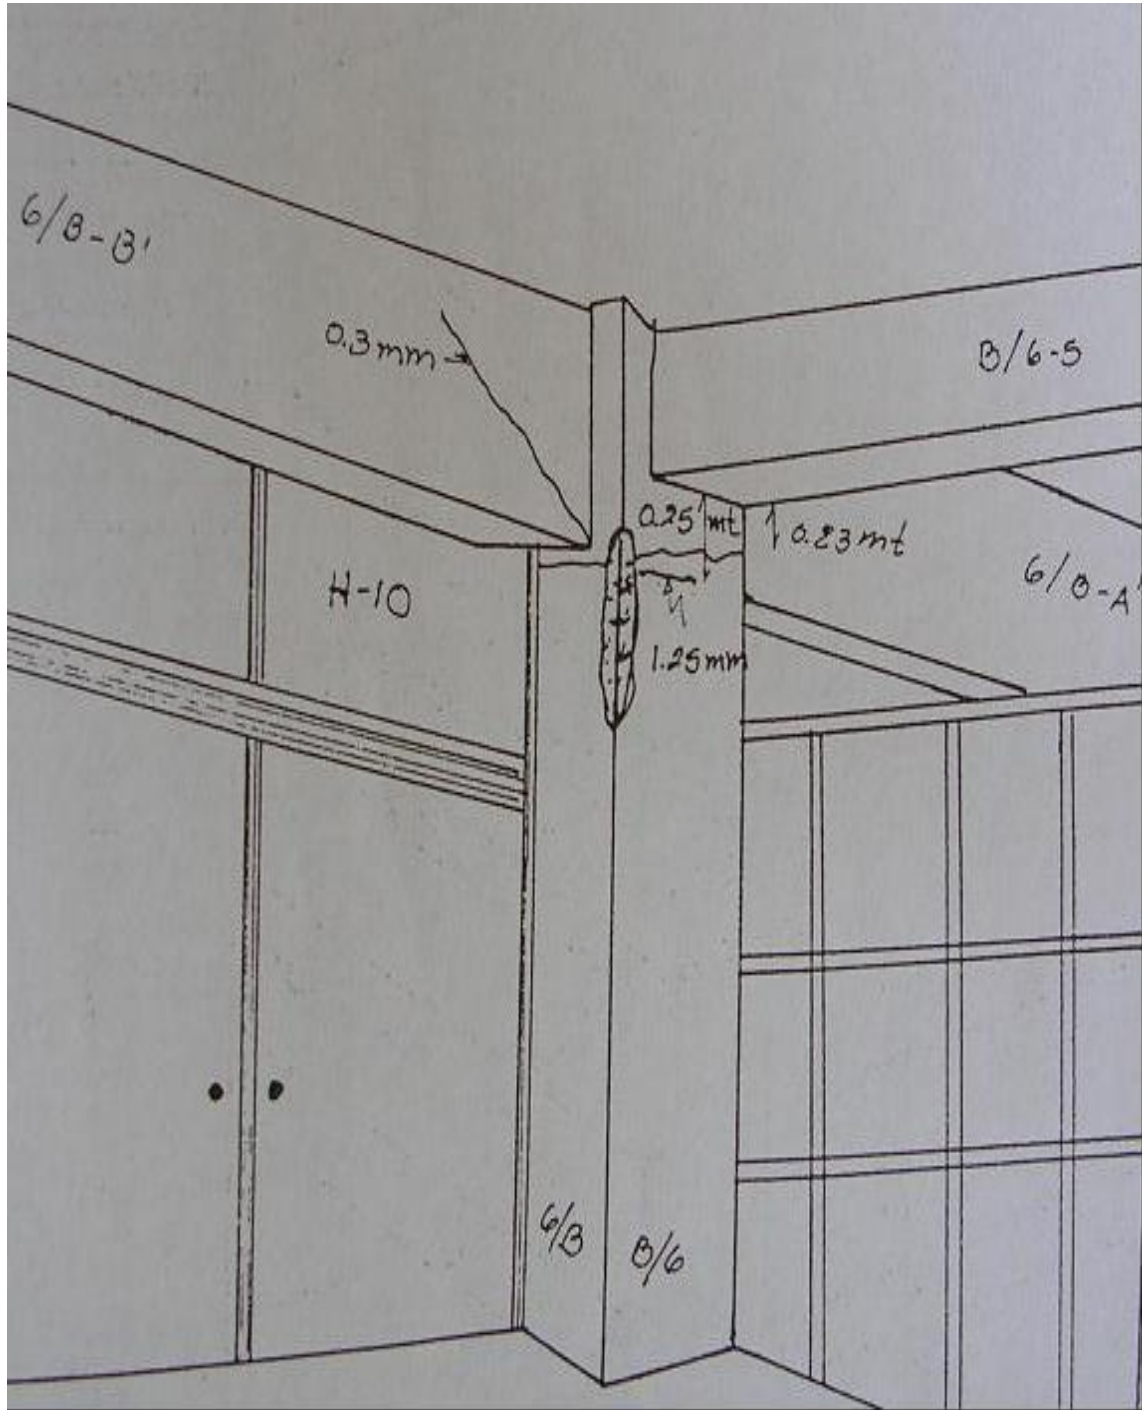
7 Ilustración de los daños en la columna B/6.
